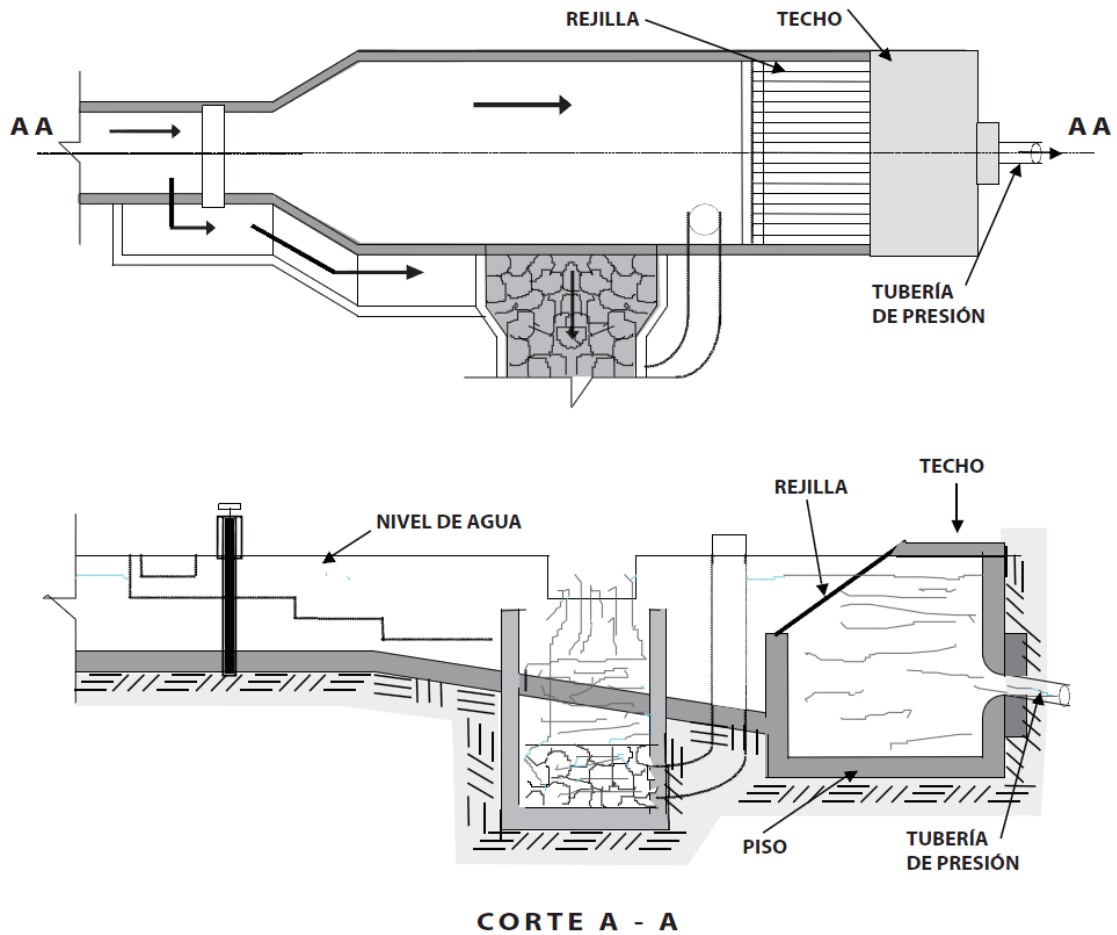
Dimensiones del tanque de presión con desarenador. [12]
